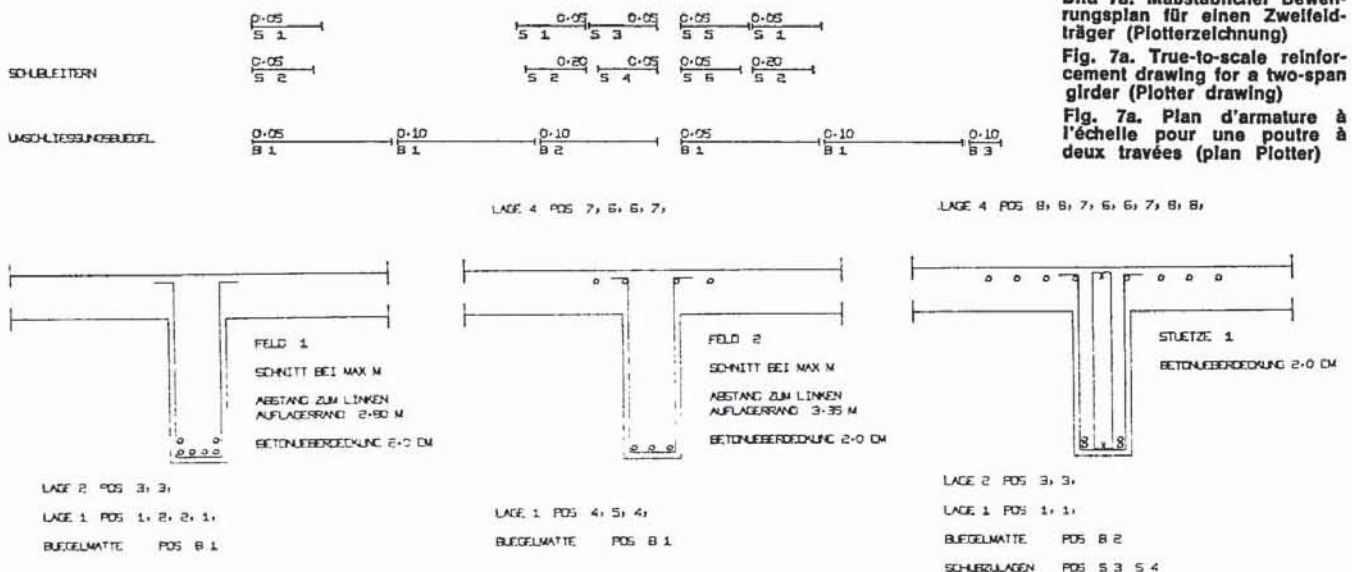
Schnitte zum maßstäblichen Bewehrungsplan nach Bild 7a (Plotterzeichnung)
